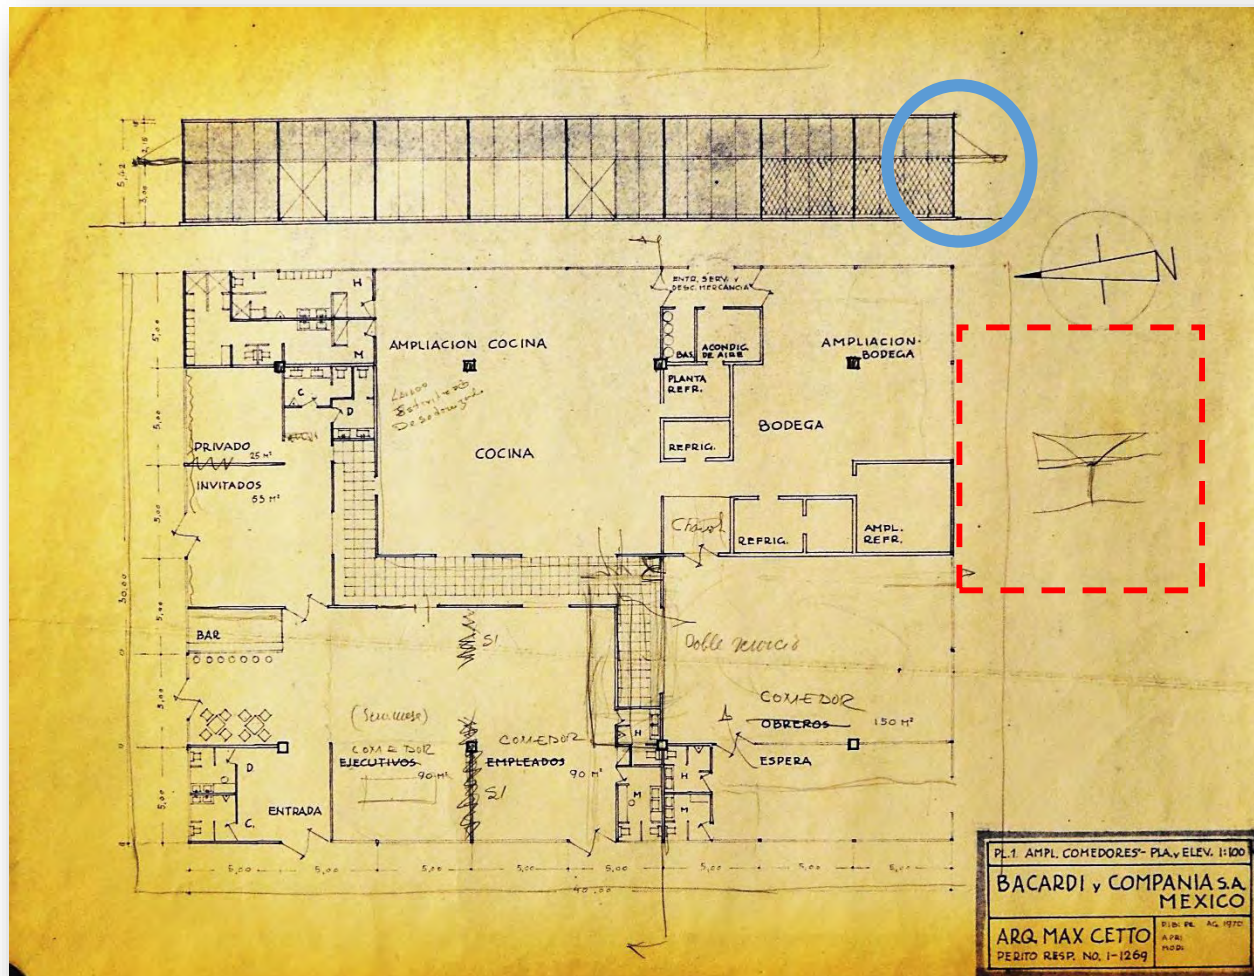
Proyecto Planta comedor y fachada Arq. Max Cetto
